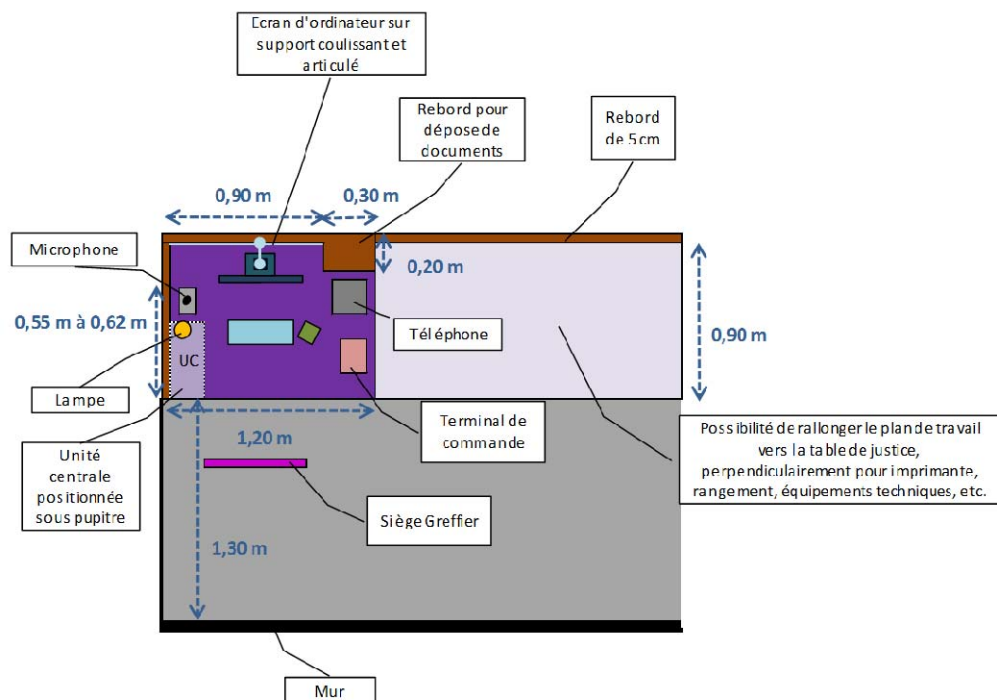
Schéma en plan, position de travail du greffier (l'auditoire est à gauche du poste de travail).
